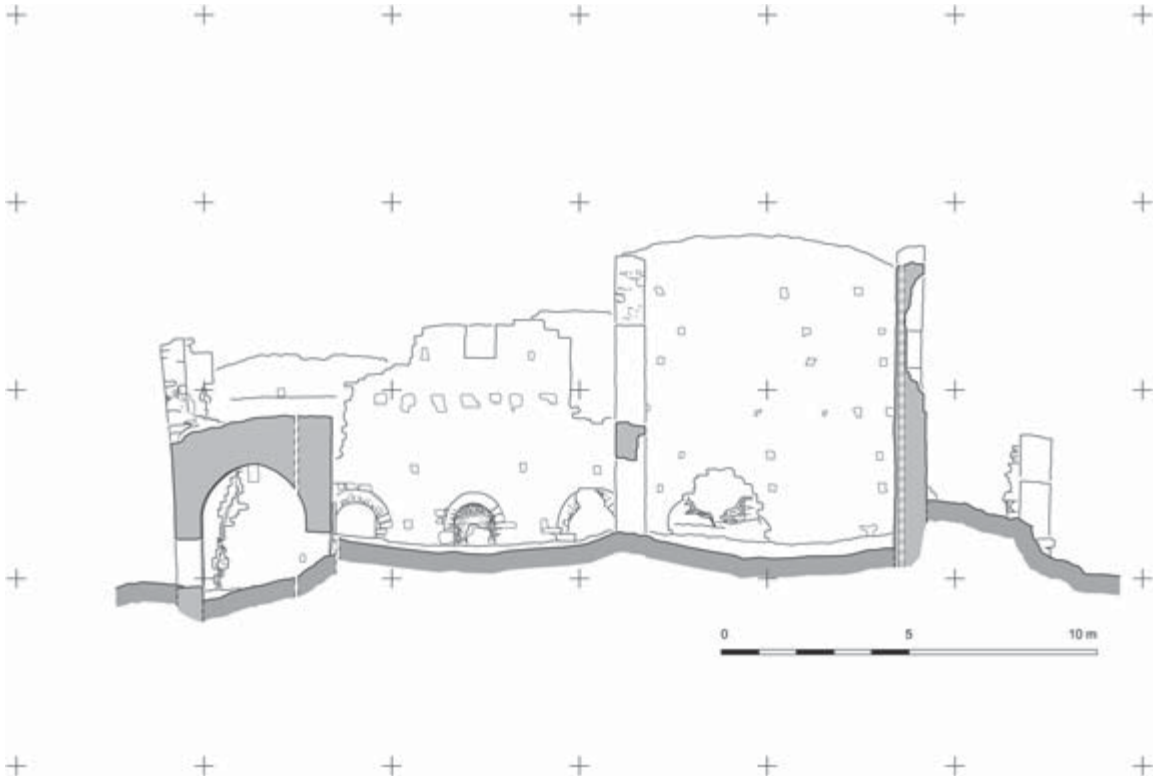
Kirse Yanı, Bauaufnahme, Längsschnitt LL nach Norden
